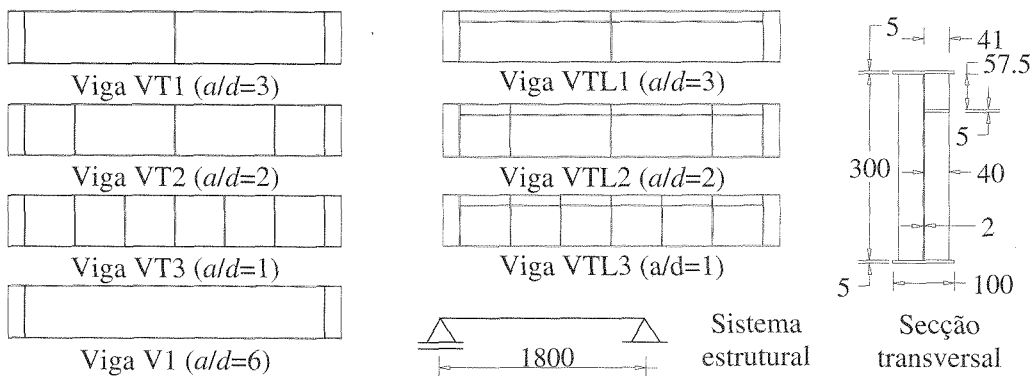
Alçados e secção transversal das vigas a estudar e ensaiar
